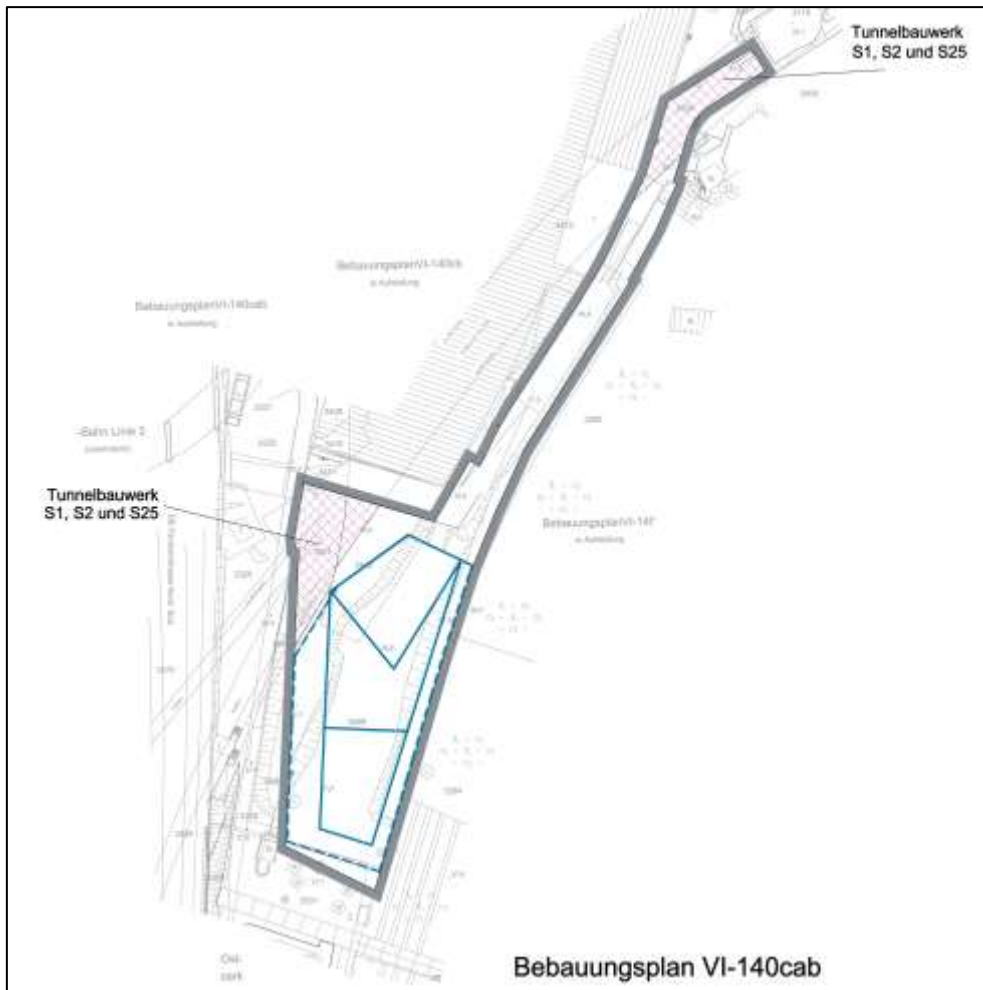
Bahnrechtlich gewidmete unterirdische Bahnanlagen / S-Bahntunnel
